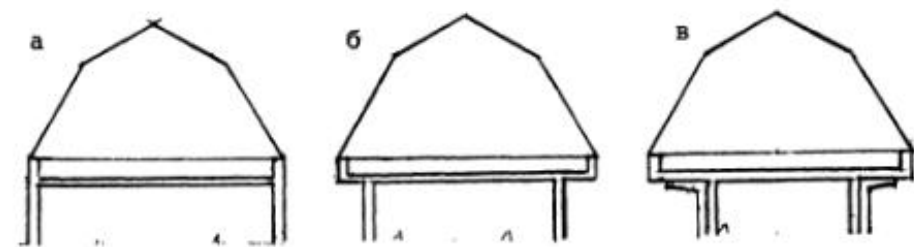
Схемы размещения мансарды: а – в створе наружных стен здания; б – с выходом за границы наружных стен на консолях перекрытия; в – то же, на дополнительных наружных опорах
